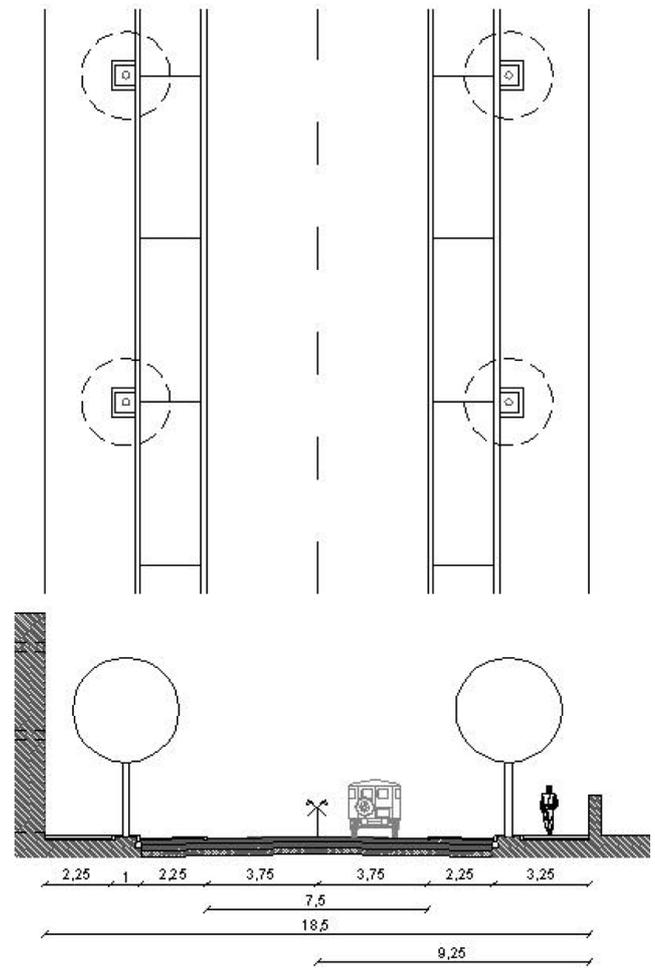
Perfil Transversal Tipo PT3 — vias municipais simples em áreas de Habitação, Comércio e Serviços
